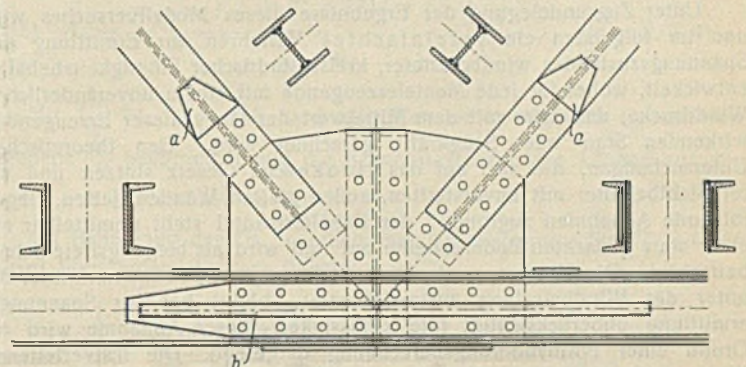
Geschweißte Fachwerkbrücke; Knotenpunkt genietet. Futter a und Flachstab b ersetzen die Nietlochschwächung.
